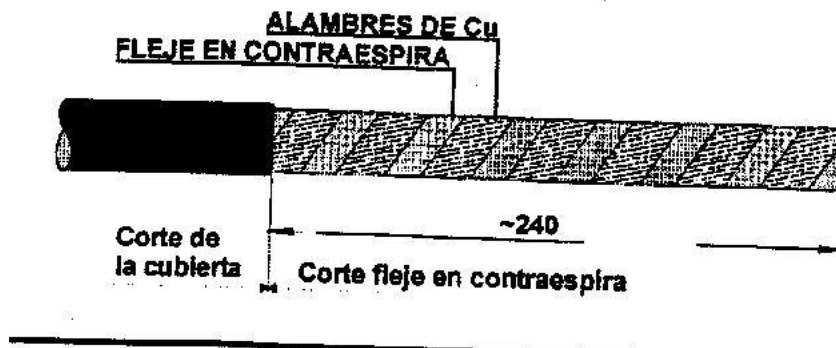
corte de cubierta, semiconductora y aislamiento.
